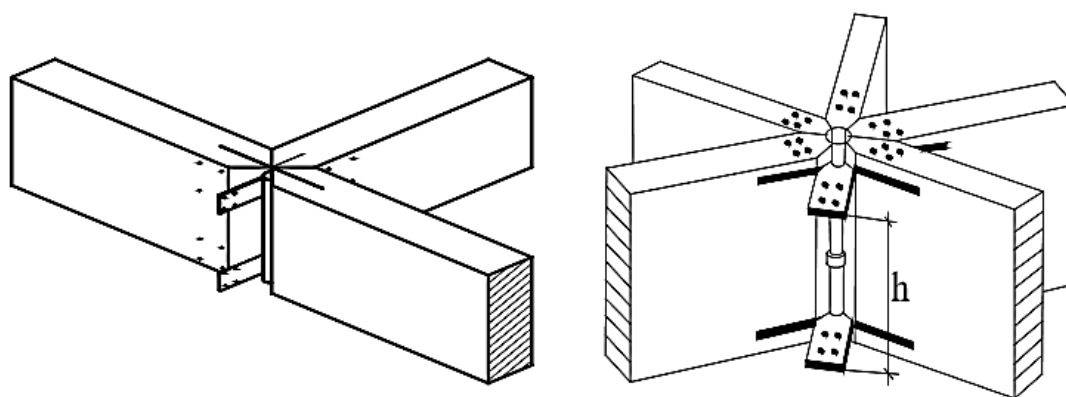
Сопряжение перекрестных деревянных балок и ферм
